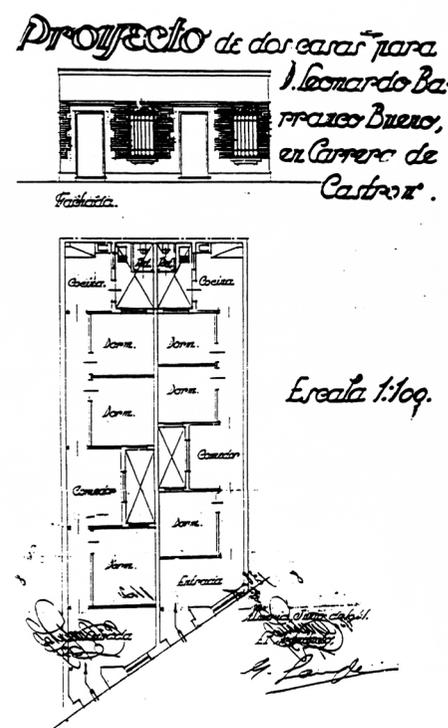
| Casa D. Leonardo Barranco. Planta y alzado (1941). Guillermo Langle Rubio.
